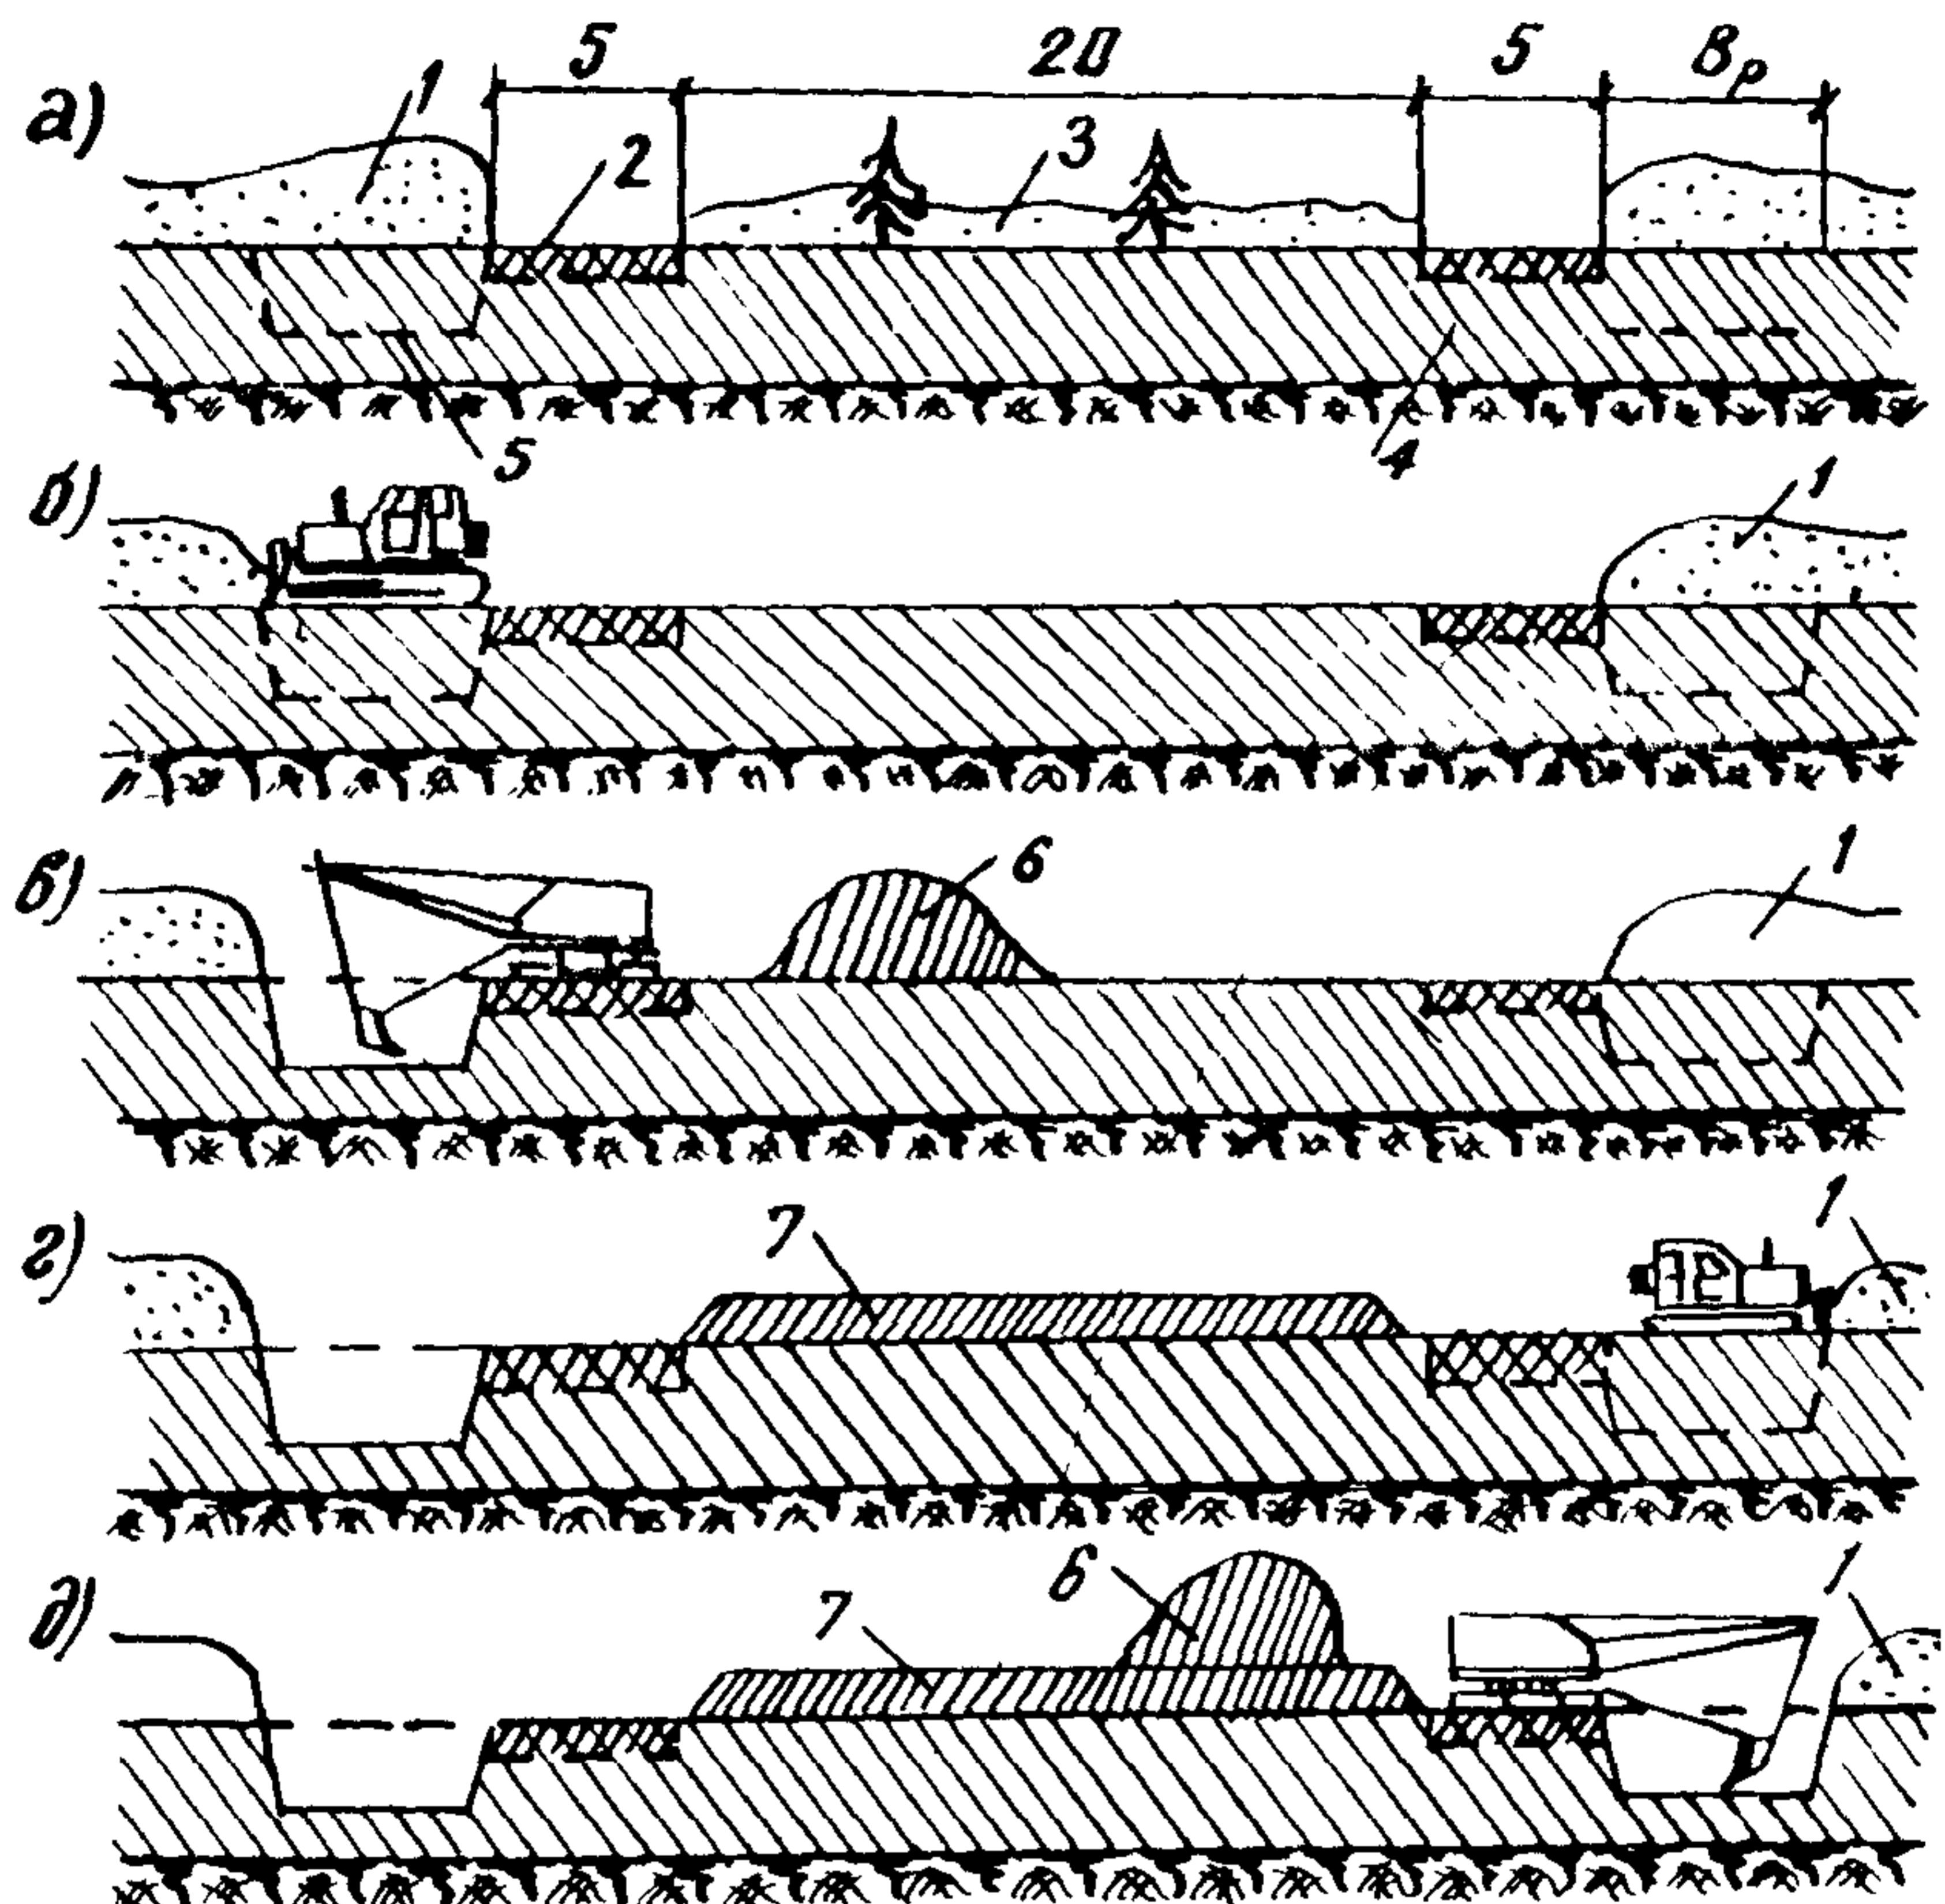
Проведение работ по устройству нижней части насыпи на болотах I и II типов:
